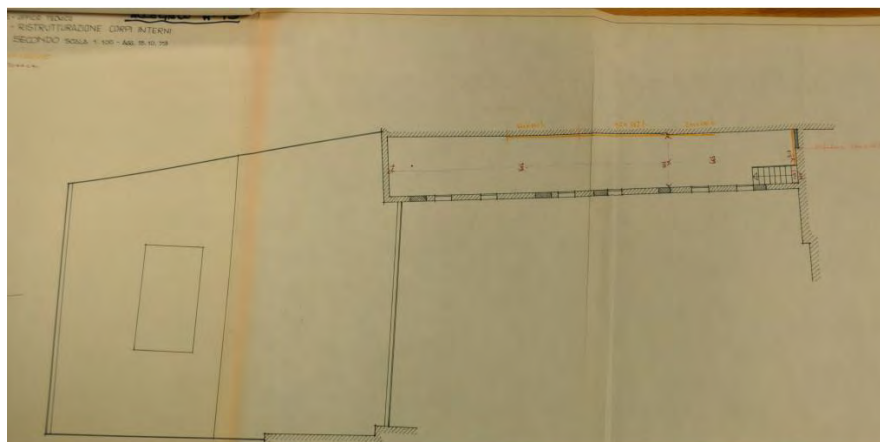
Restauro 1973, Pianta Piano Secondo
